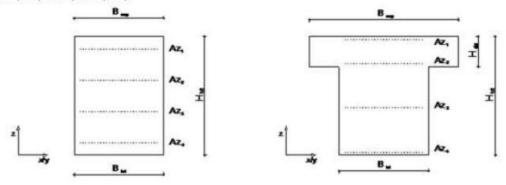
Telai: Posizione ed area degli strati di armatura longitudinale.
